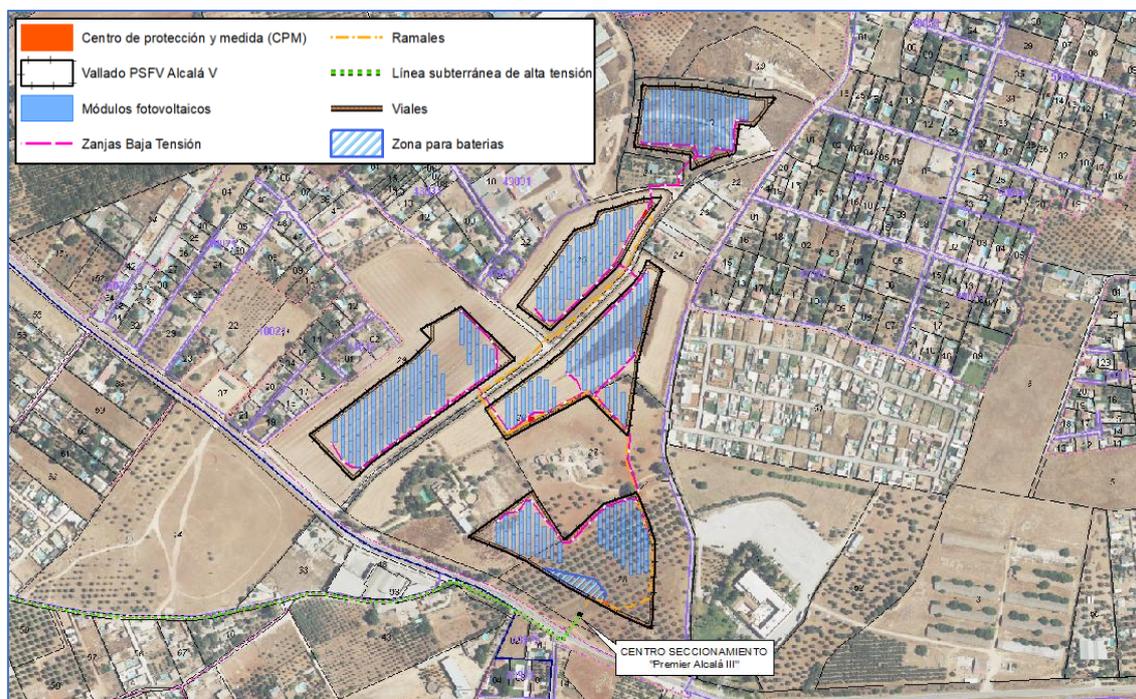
Localización de la Planta Solar Fotovoltaica en proyecto. Fuente propia.
